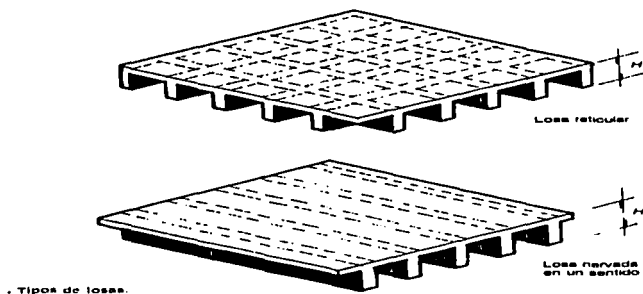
Losas nervadas, para trabajo estructural en dos y un sentido.
